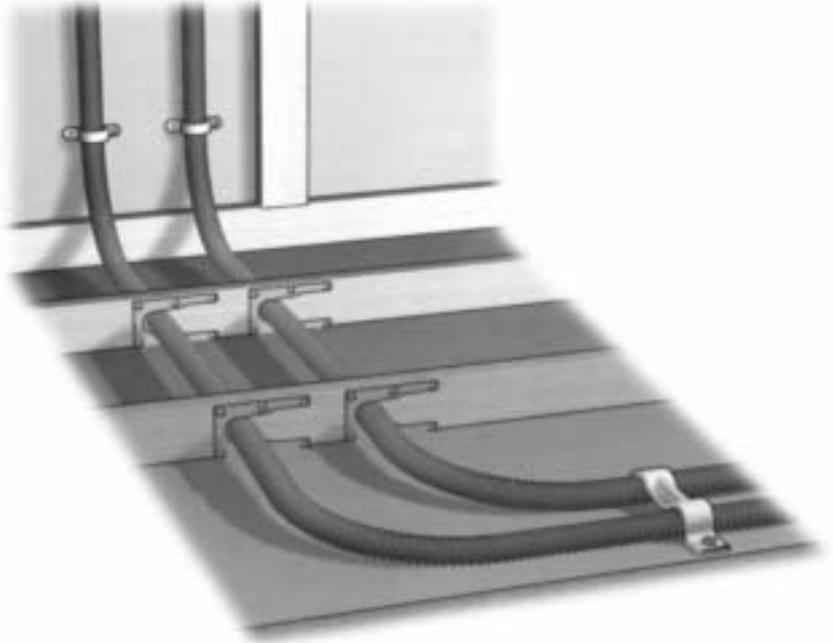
Кожух, проходящий через балки, с крепежными скобами и фиксирующими пластинами
